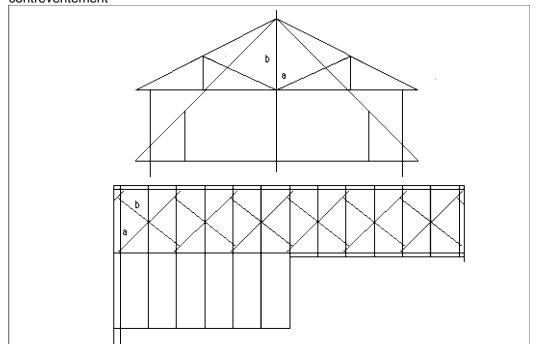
C) Exemple de rigidification longitudinale sur chien-assis symétriques, par renforcement du contreventement
